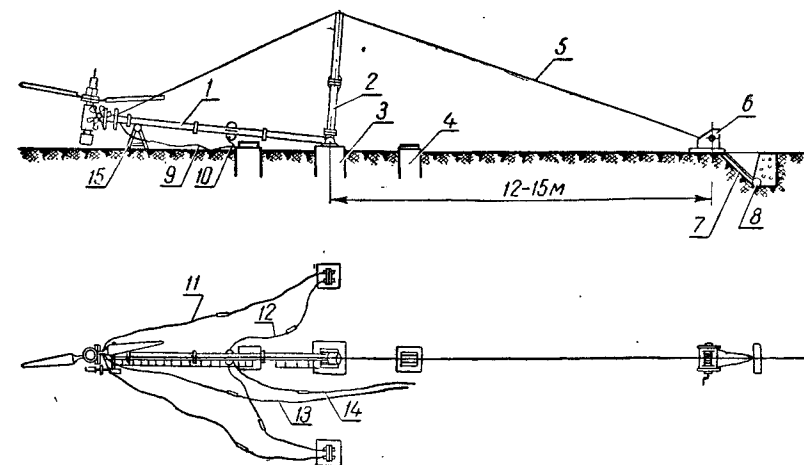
Оснастка агрегата ВЭС-1-5 для подъема:
